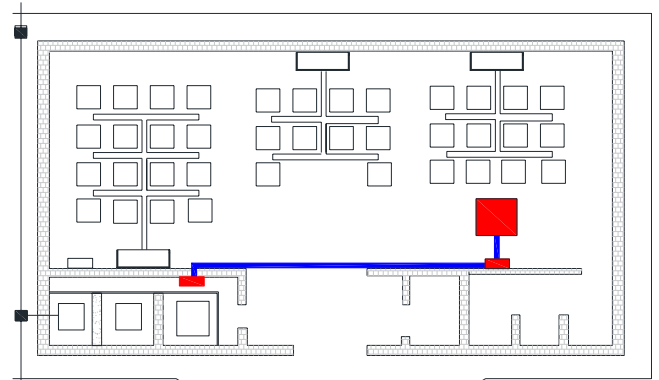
Planta baixa de uma indústria atendida em média tensão.
